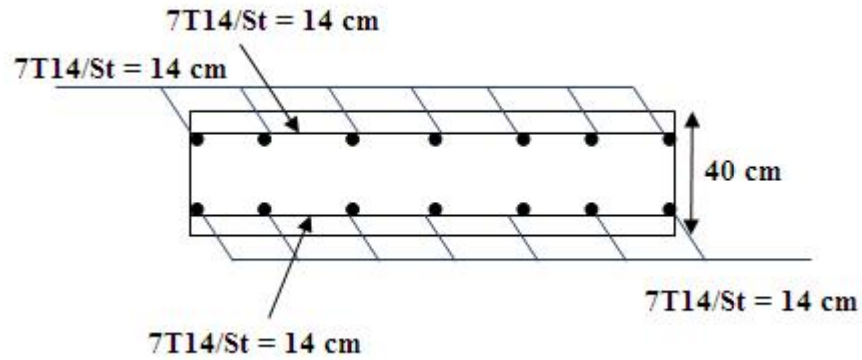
Ferrailage de la dalle du radier pour une bande de 1m
